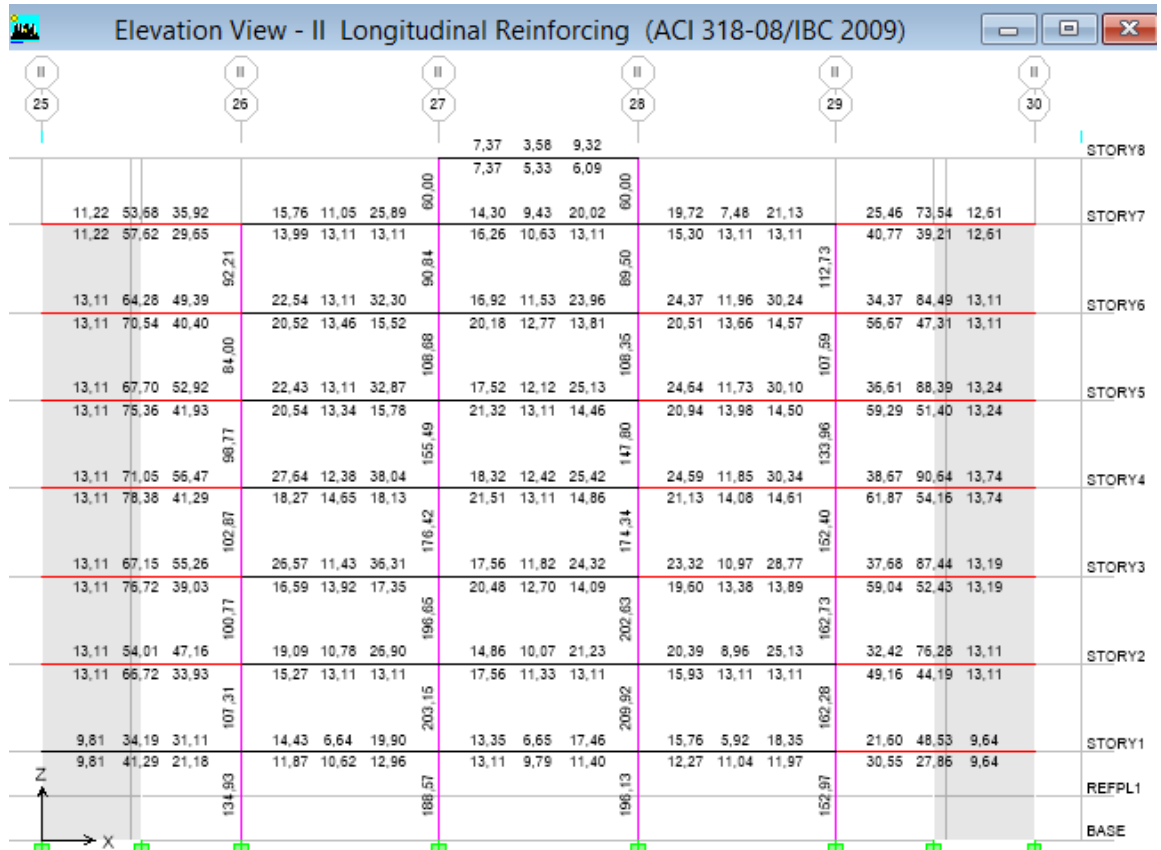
Acero en Vigas y Columnas en el Pórtico II – Hospitalización 2- (NEC-11)
